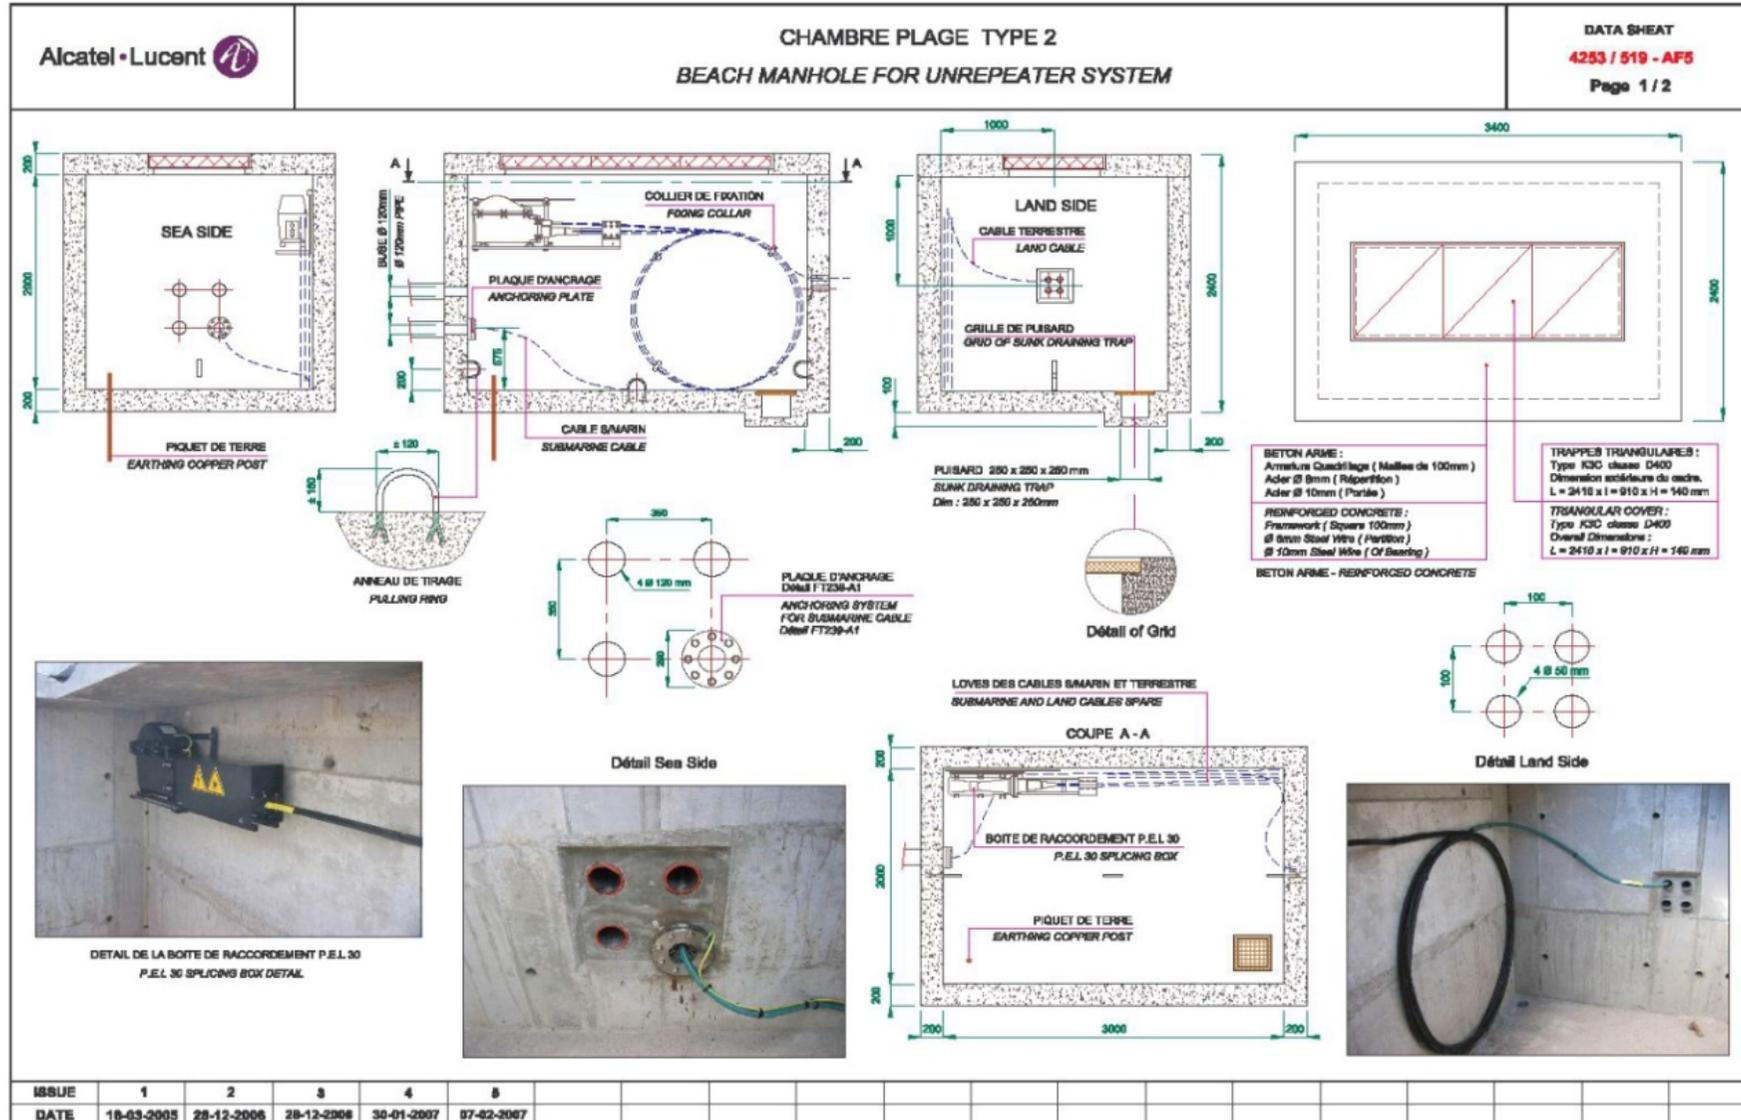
Plan de chambre de plage et disposition du joint et boucle de câble (source : Alcatel).
